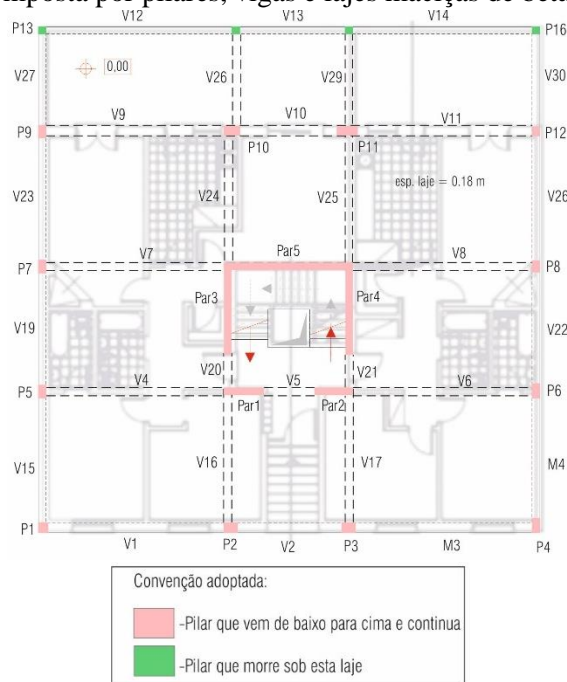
Planta de implantação dos pilares no piso do R/C
